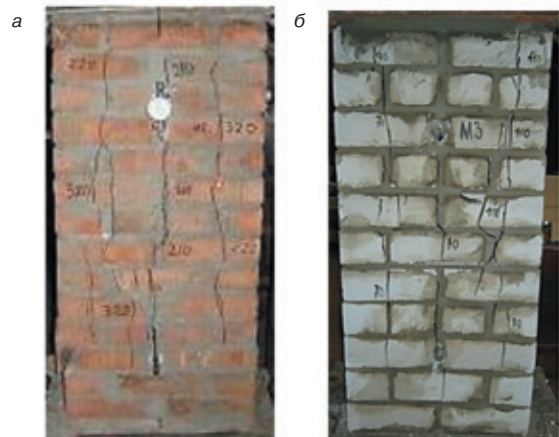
Последняя стадия разрушения кладки без горизонтального армирования с разделением на отдельные вертикальные трещины. Испытания автора, 2006 г.: а – из керамического кирпича; б – из силикатного кирпича
